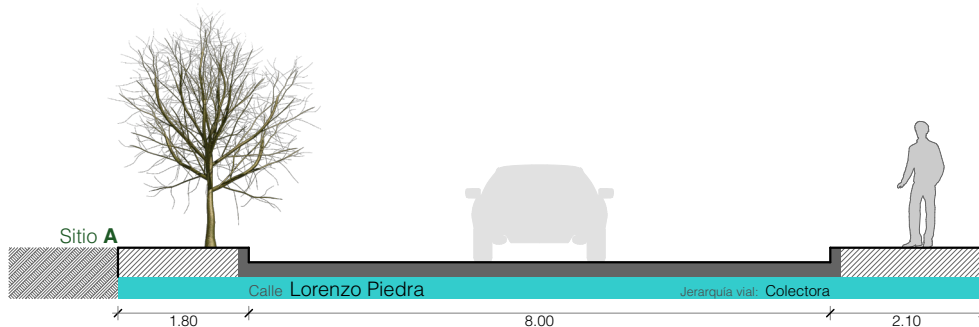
\_ Sección de la calle Lorenzo Piedra
